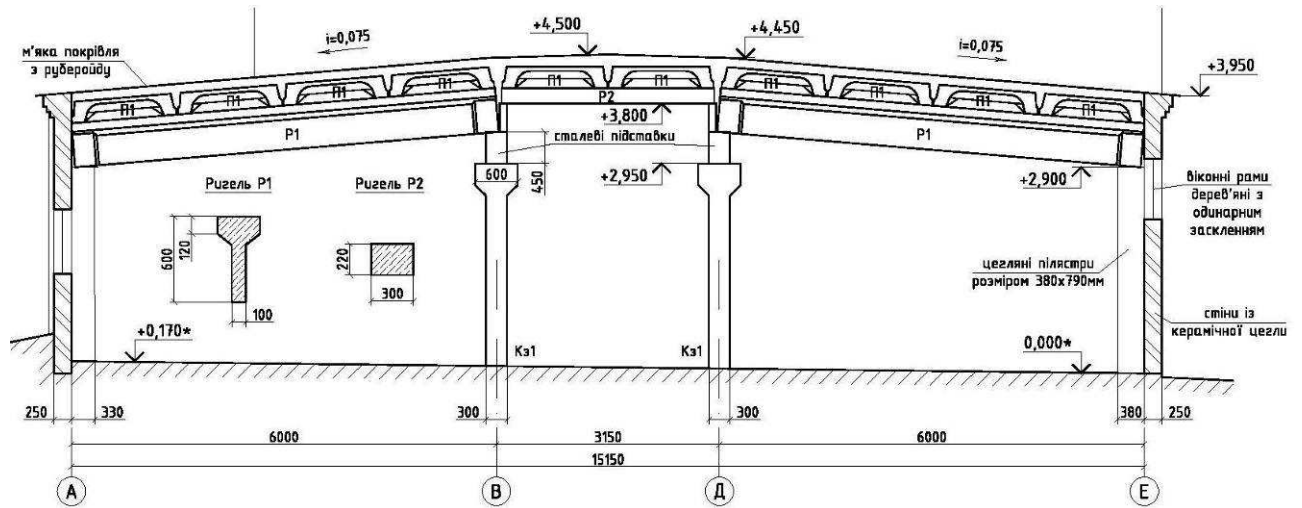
Поперечний розріз 4-4 між осями 9-15 будівлі цеху фасування, складу тари
